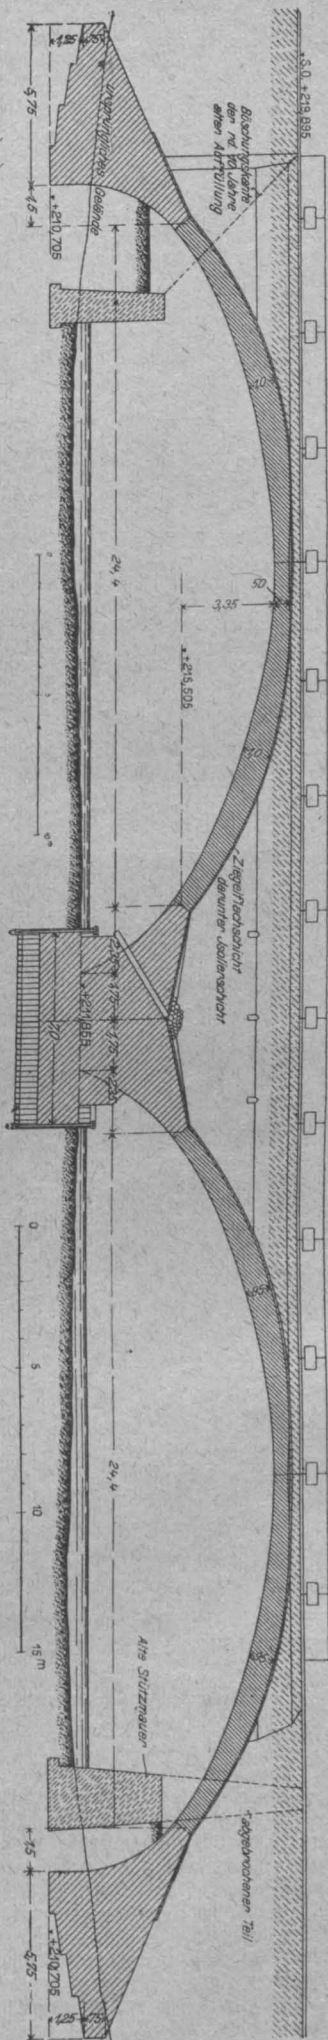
Längsschnitt durch das Brückenbauwerk. Abbildung 4. Grundriß.
